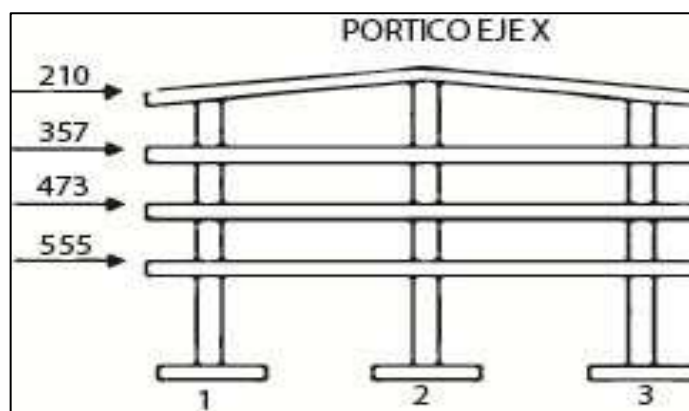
Ilustración de fuerzas cortantes que actúan en la estructura (Eje X); Fuente: [Grupo investigador]
